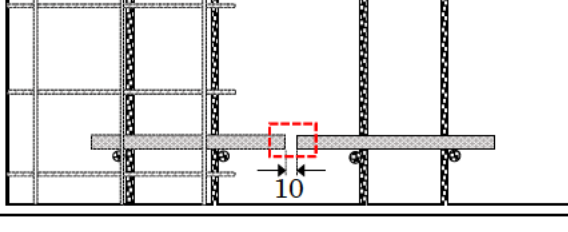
ダウエルバー、チェア、鉄網の配置状況
